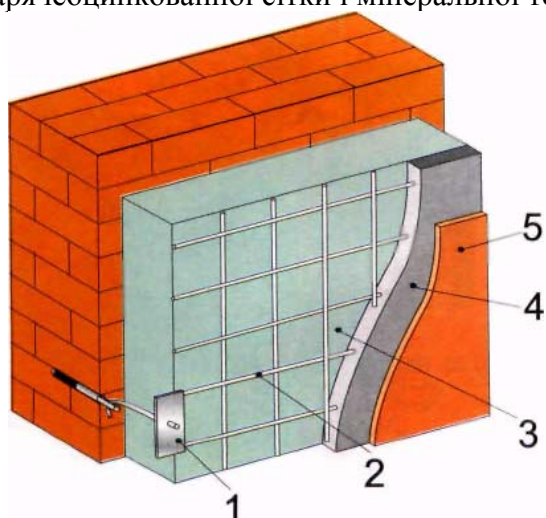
Система влаштування фасаду системи скріпленої теплоізоляції:
